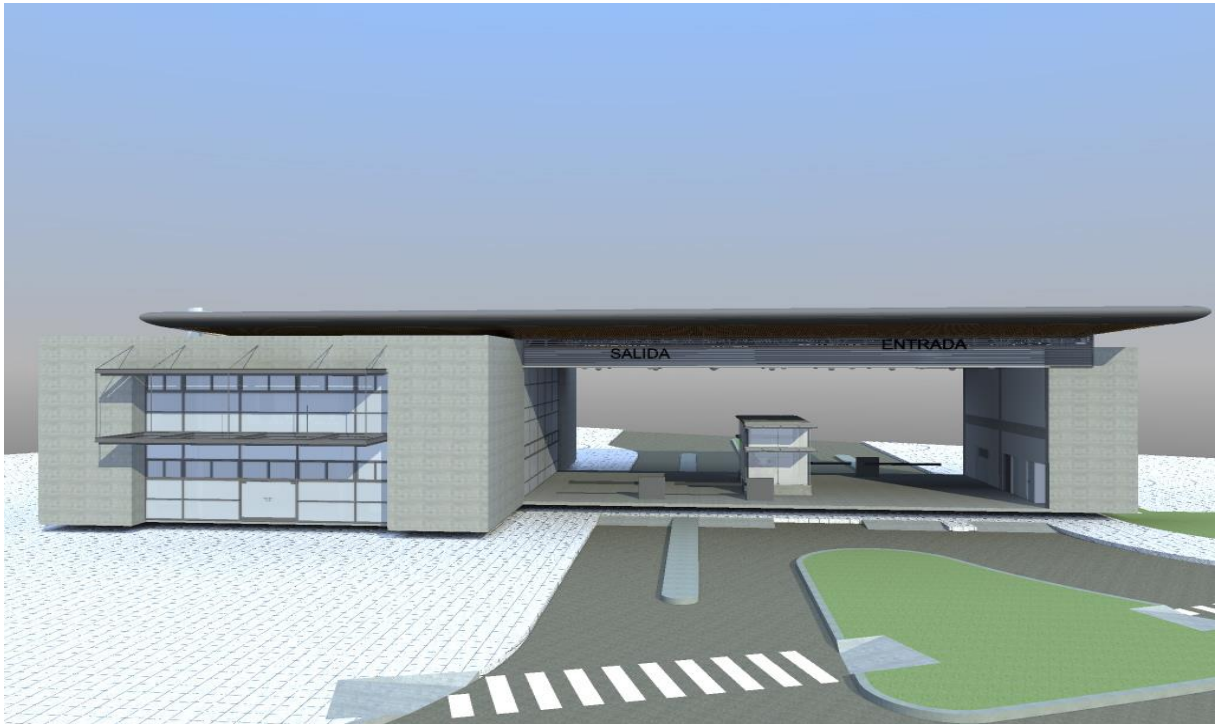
Render Portal de Acceso – Tomado Planos Arquitectónicos
